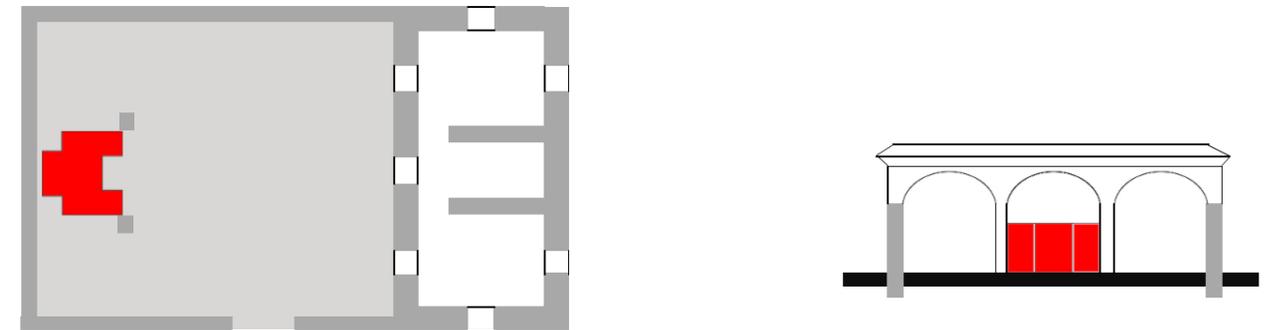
Schemi di collocazione in pianta e in prospetto del Modulo Abitativo MAACC all'interno dei Caselli di Controllo del Canale Cavour, fonte: elaborazione immagine dell'autore
